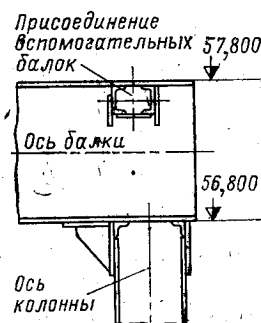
Крепление сварной двутавровой балки на колонне
